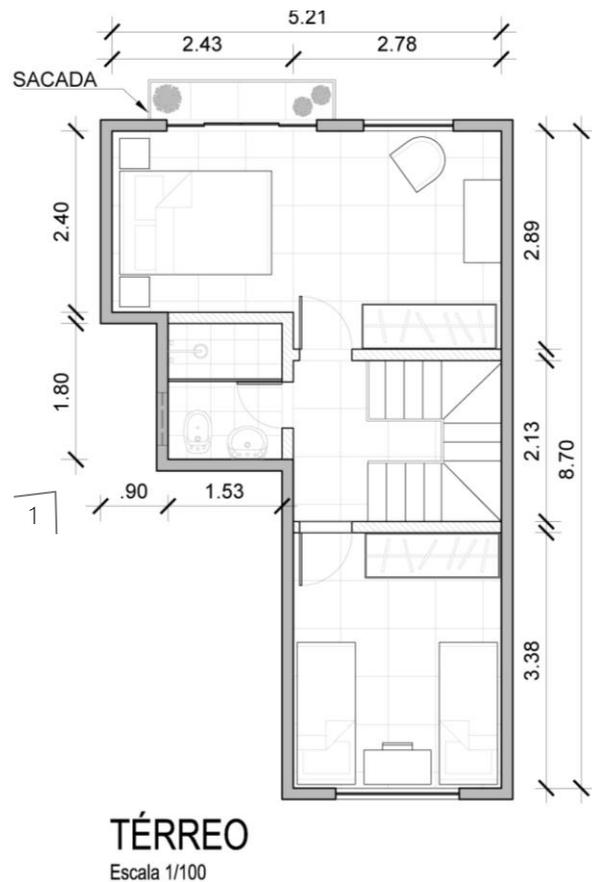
Situação em planta apartamento 2 quartos duplex. Fonte: Elaborado pela autora.
